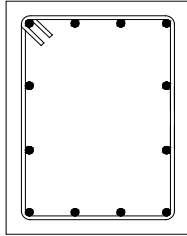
Kolom 1 Lantai Dasar s/d Lantai 2
